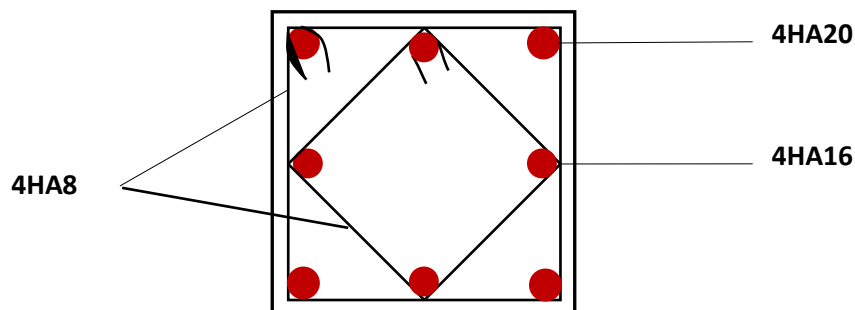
Schéma de ferrailage du poteau 50x50
